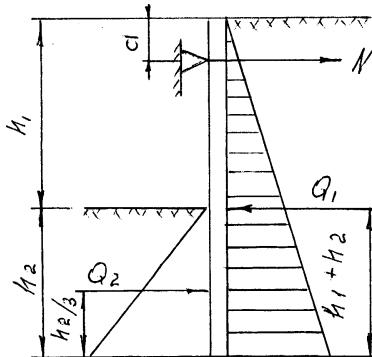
Расчетная схема тонкой заанкеренной подпорной стены
